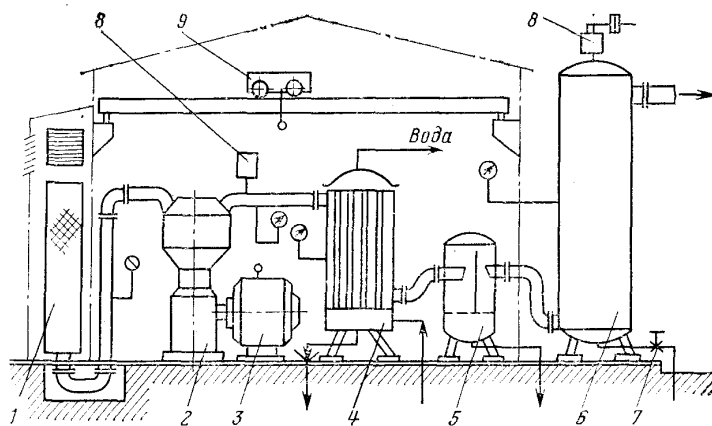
Схема компрессорной установки с поршневыми компрессорами:
